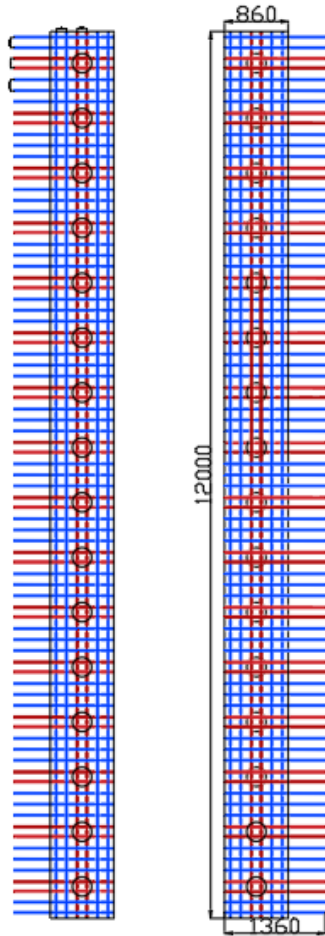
Armaduras completas de la Pila 4 con 16 micropilotes
